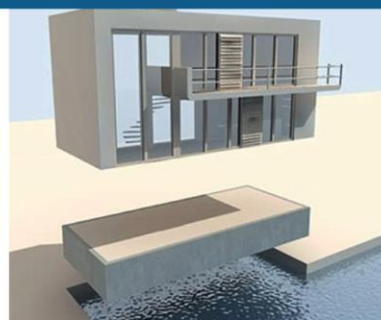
maison sur un caisson flottant encastré dans la terre ferme
